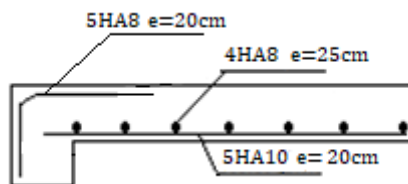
Schéma de ferrailage de la dalle sur 3 appuis
